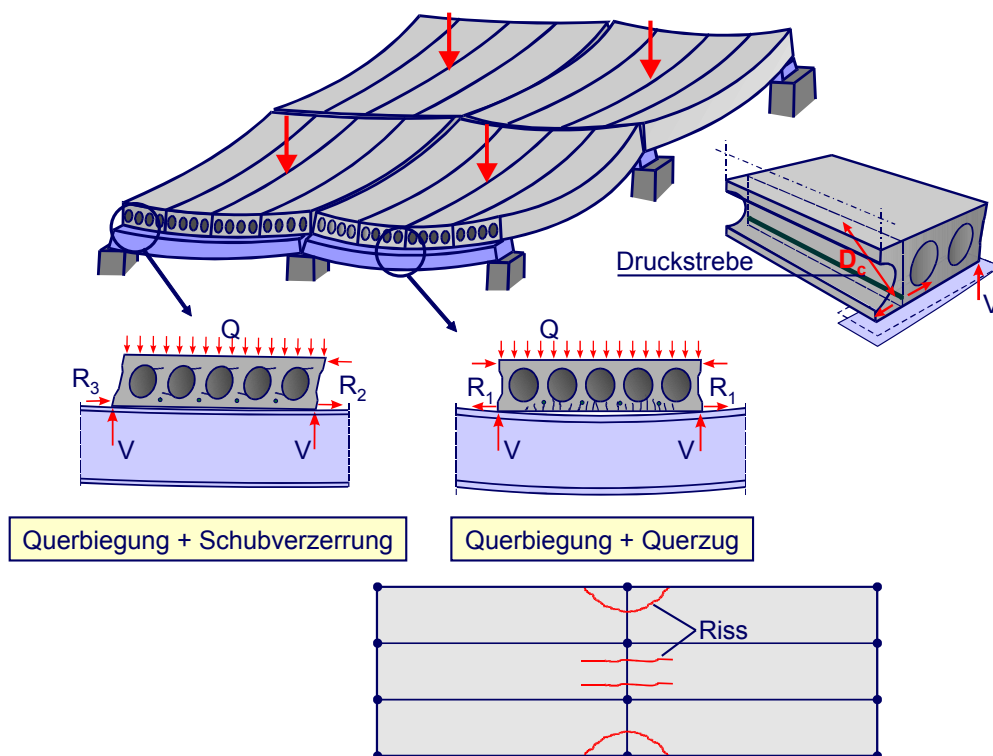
Spannbetonhohldielen bei biegeweicher Lagerung
